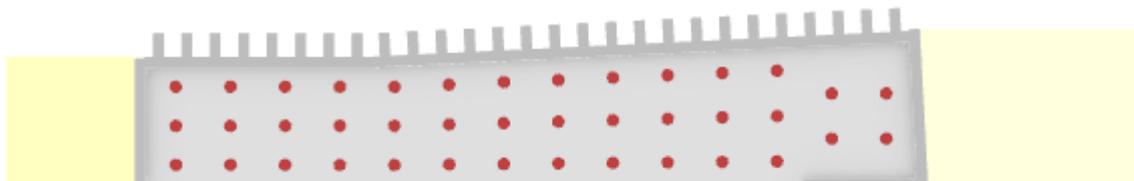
Vista in pianta pozzo : pali di ancoraggio
